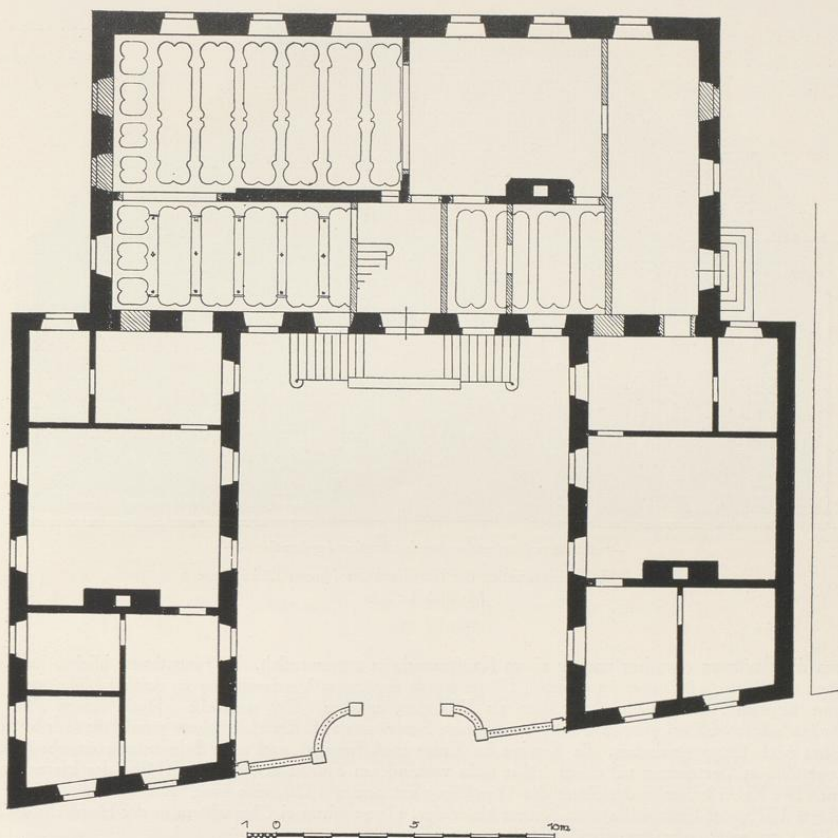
Grundriß des Hauses Lütke Gasse 5; Maßstab 1 : 200; Norden unten
